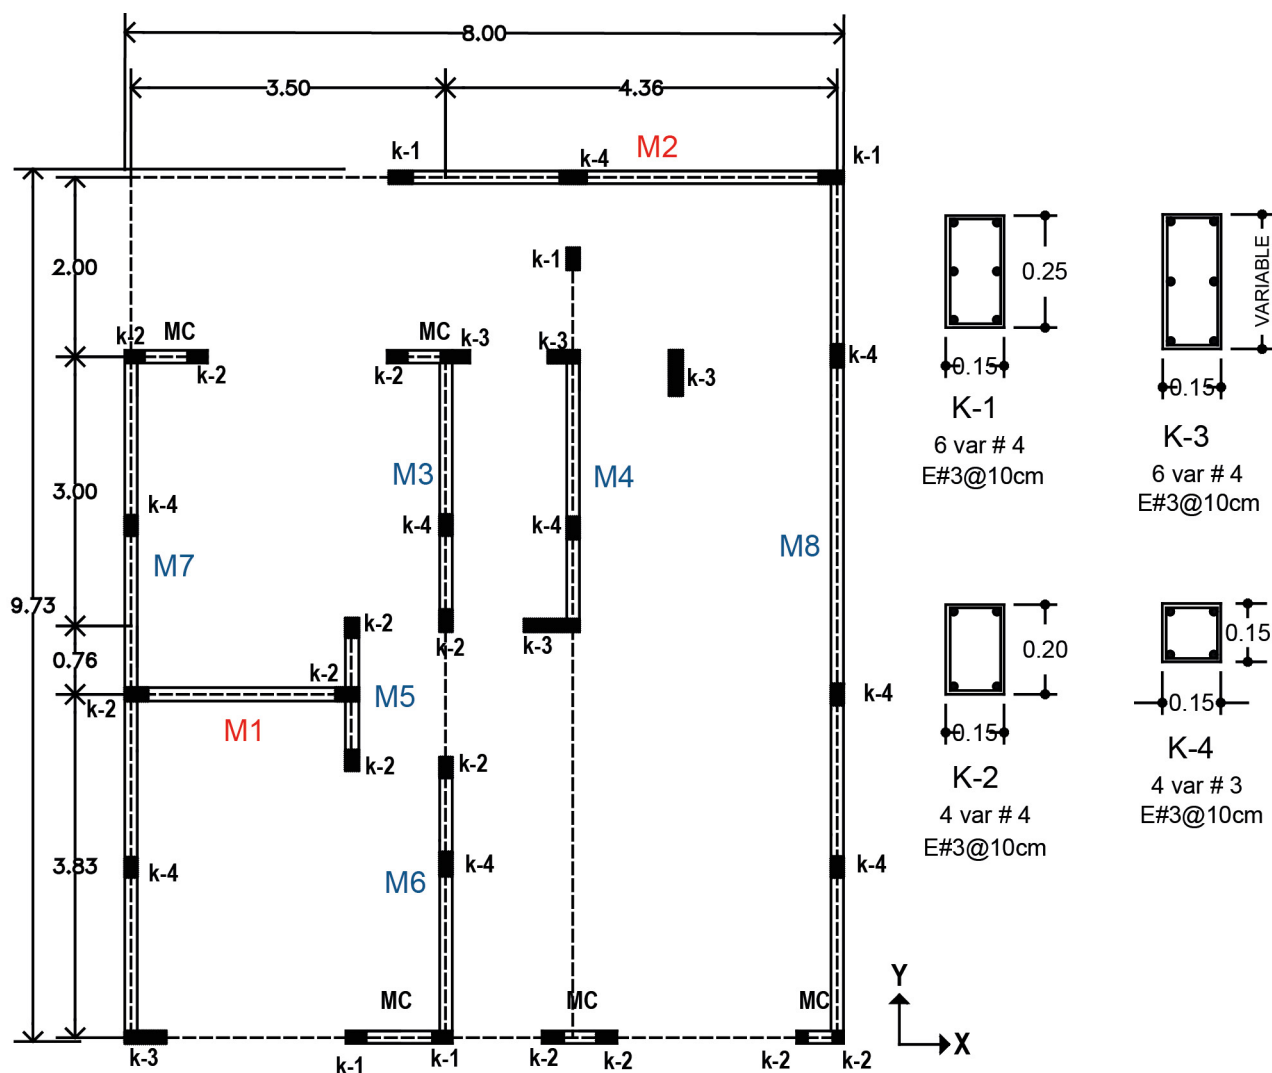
Planta tipo y distribución de muros (estructura #4). Acotaciones en m.
